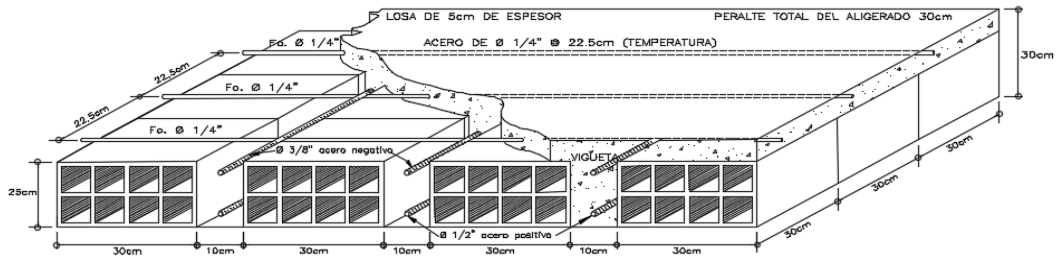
Detalles de la losa aligerada en una dirección. Fuente: el autor
